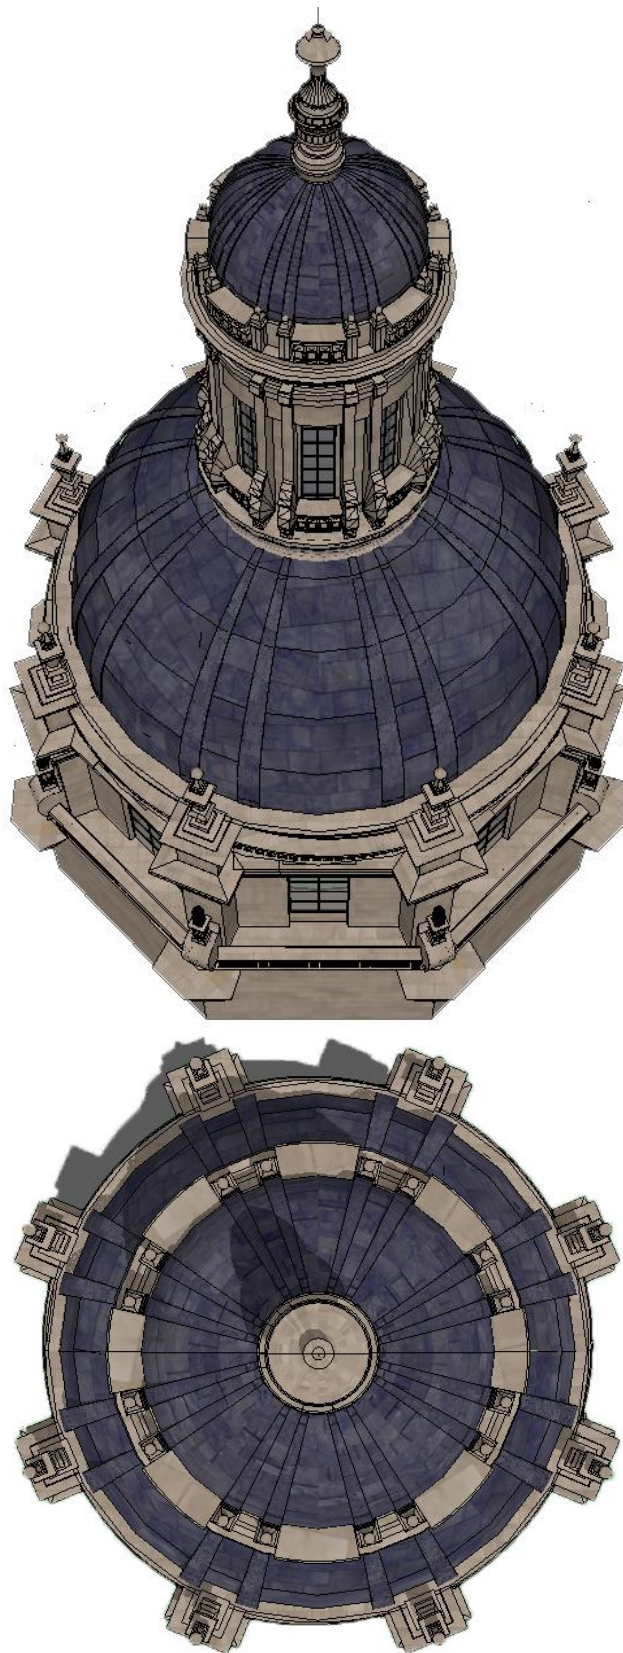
y 63- Volumetría contexturas de la cúpula en vista planta y vista aérea. Elaboración propia.
